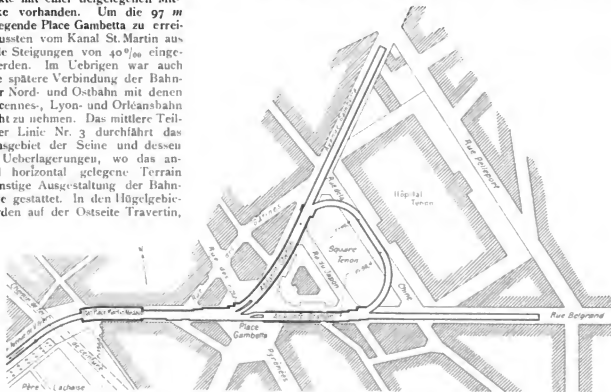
Endstation unter der Place Gambetta. — Lageplan. — Massstab 1:5000.
